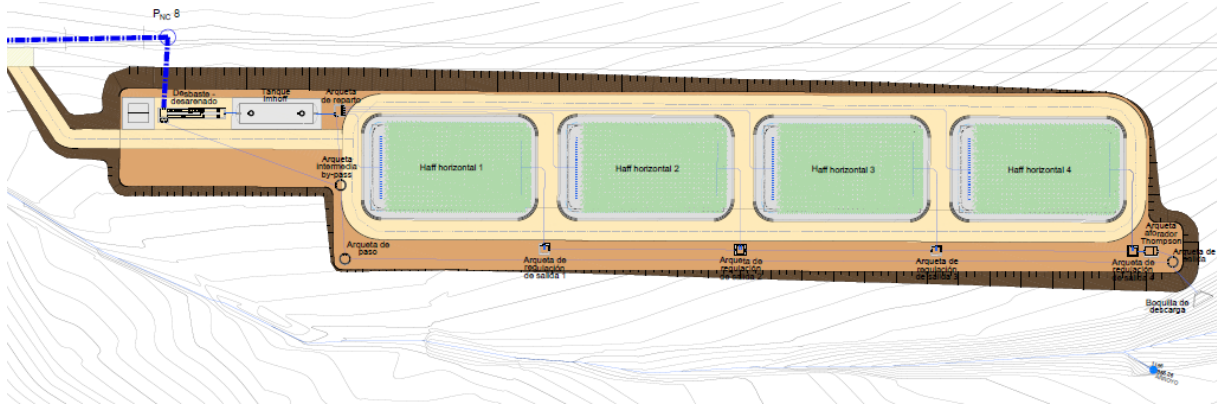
PLANTA EDAR (PLAN ESPECIAL)
